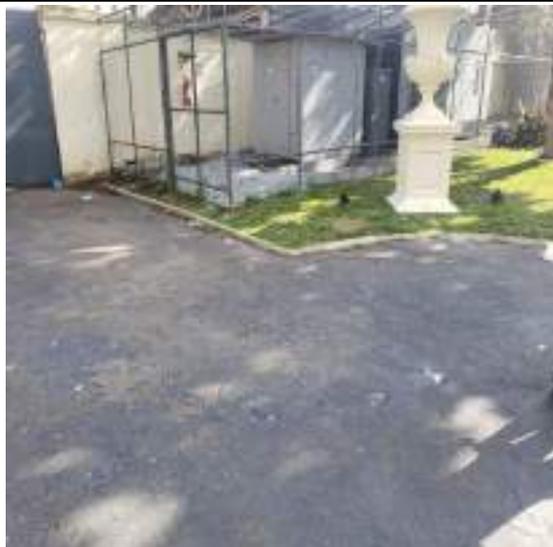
Conservação dos elementos de divisão da pavimentação da área externa. (Gramado e piso asfáltico)
